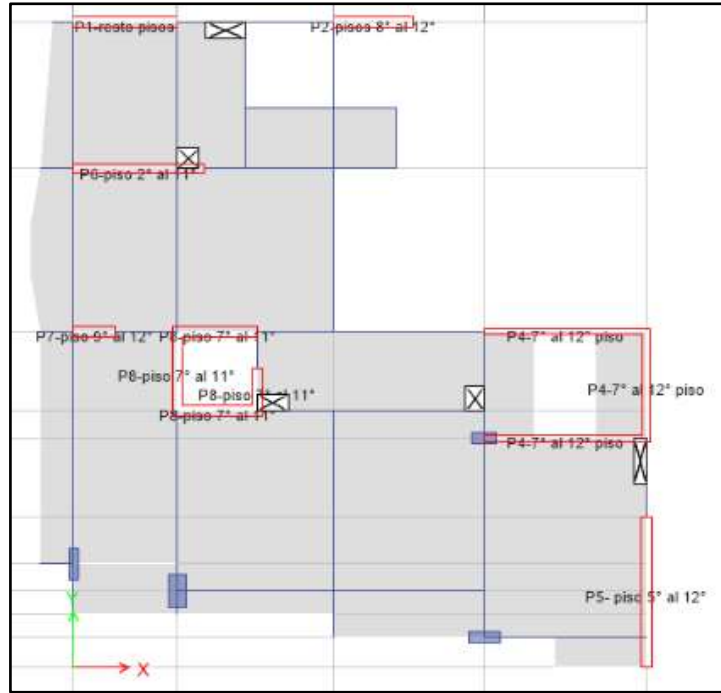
Vista en planta de M1 (piso 10° al 11°) en ETABS
